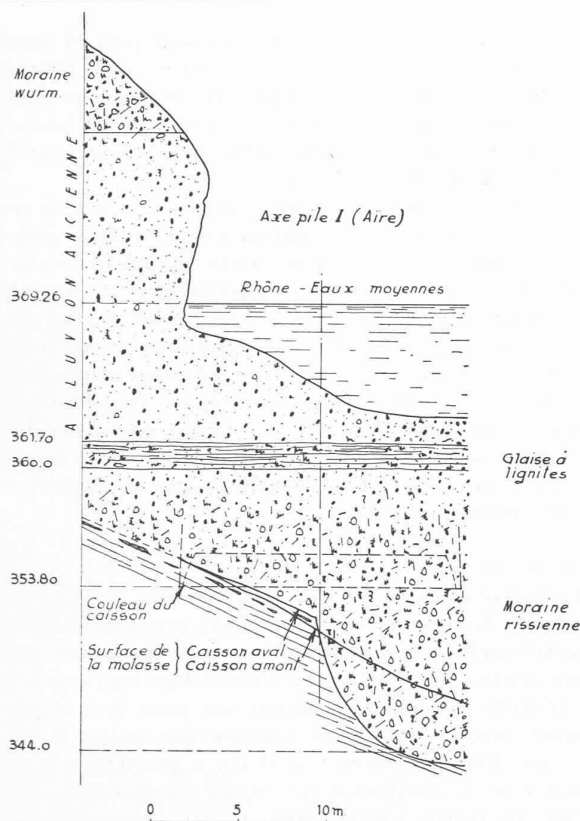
Pont Butin : fondations de la pile de rive droite.
